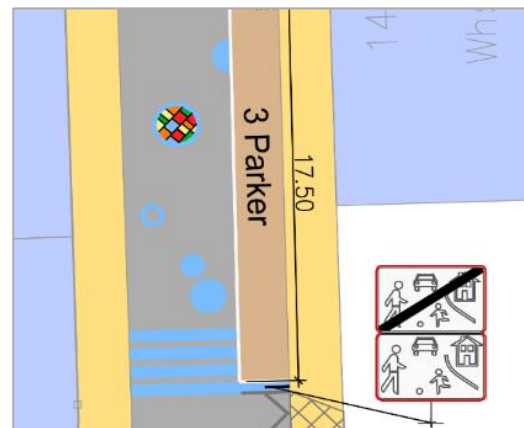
Plan zur Umgestaltung Oberritzstraße mit bunter Farbgestaltung
